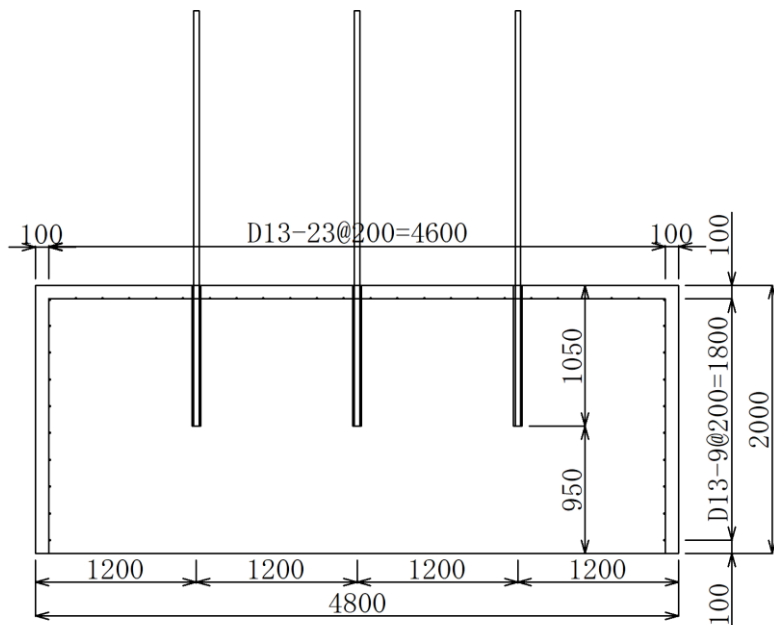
(4) 実験体①の配筋図 (C-C 断面図)
